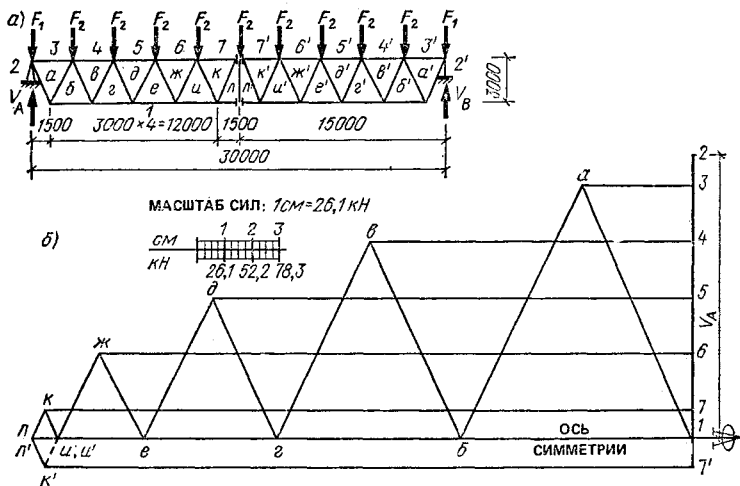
Определение усилий в стержнях фермы из ГСП
